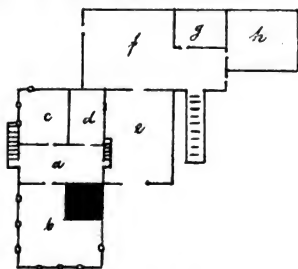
Grundriss des vorigen Hauses.
